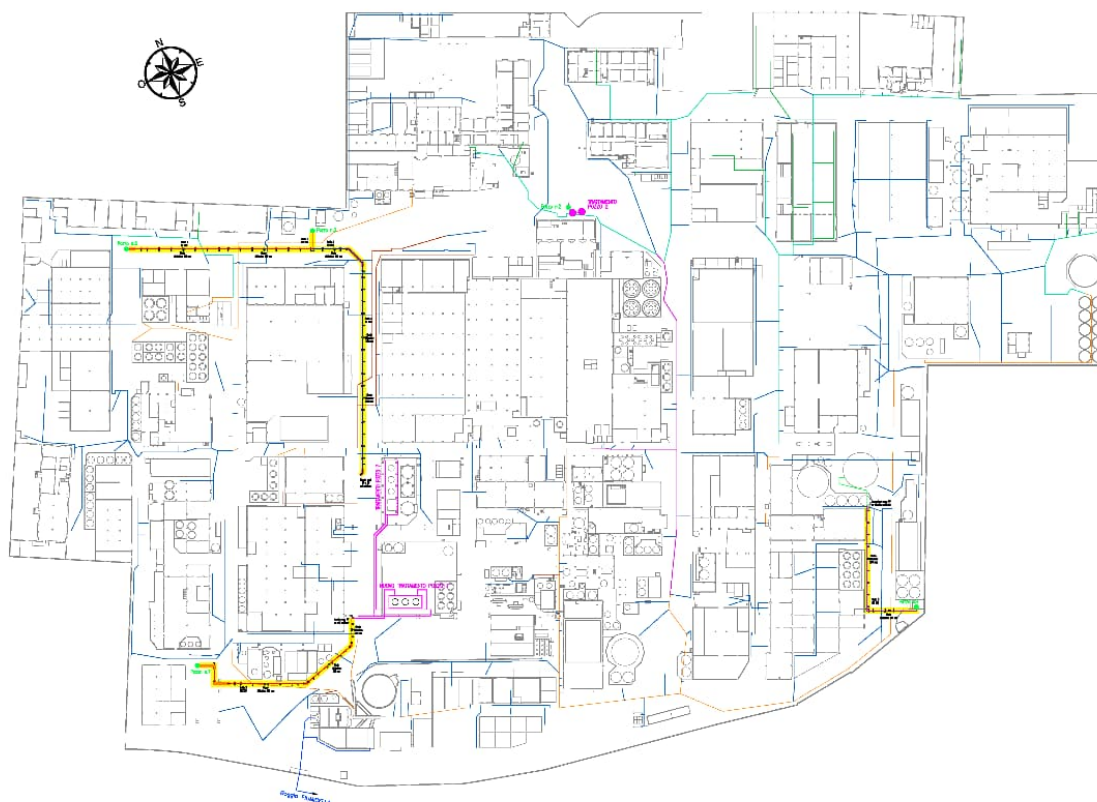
Configurazione della rete idraulica da Proposta di Variante
